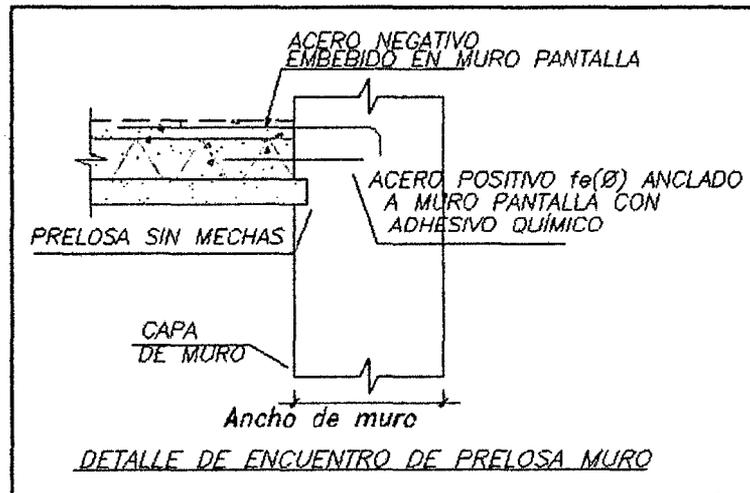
24: Detalle de prelosa aligerada y encuentro con Muro pantalla
